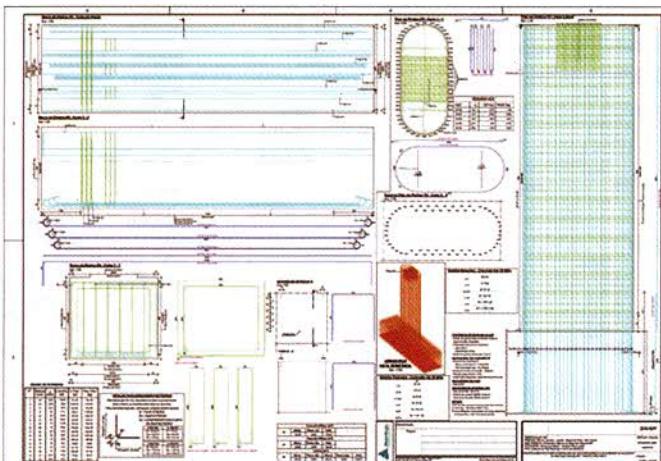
Plan armare pilă în „Allplan Inginierie”
